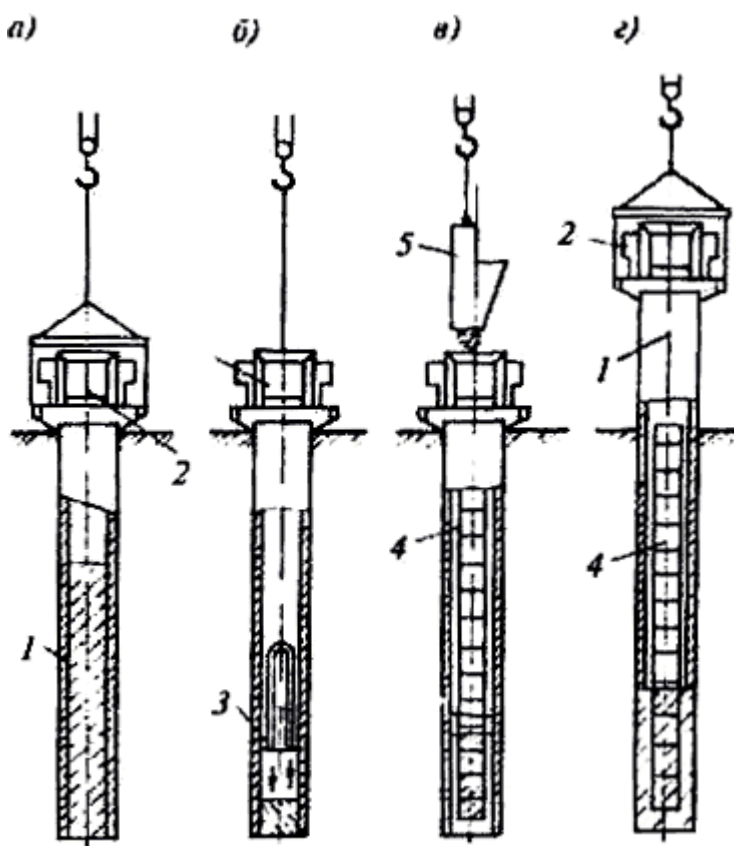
Технологическая схема изготовления набивных свай с выемкой грунта под защитой обсадных труб:
